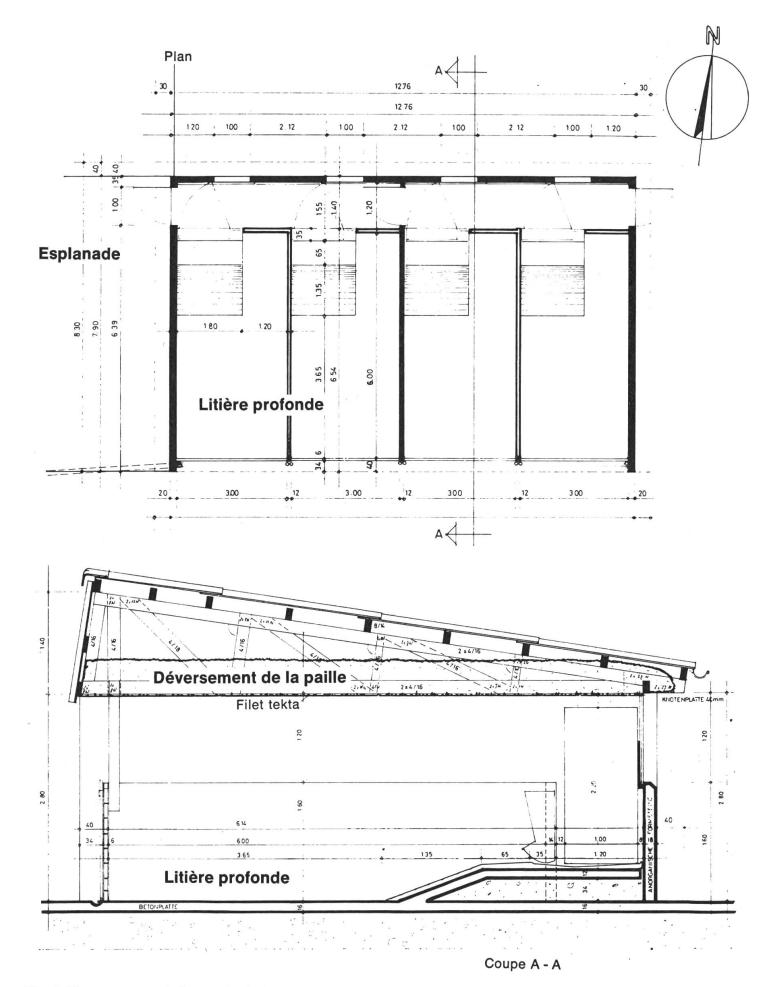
Plan et coupe de la porcherie à front ouvert.
